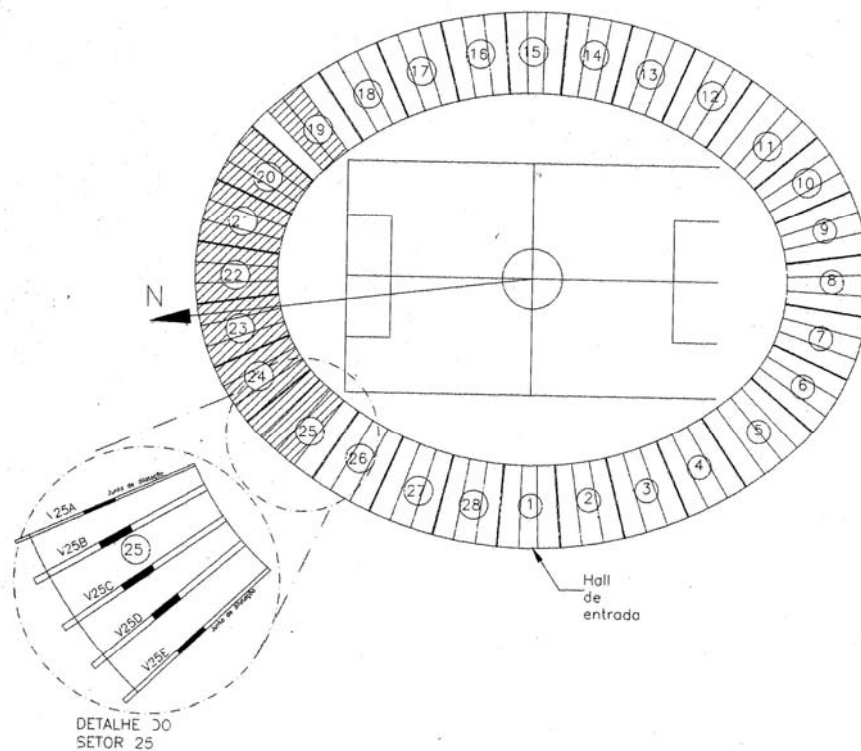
Localização das vigas de arquibancada em que foram feitos os levantamentos das fissuras – setores 19 ao 25
